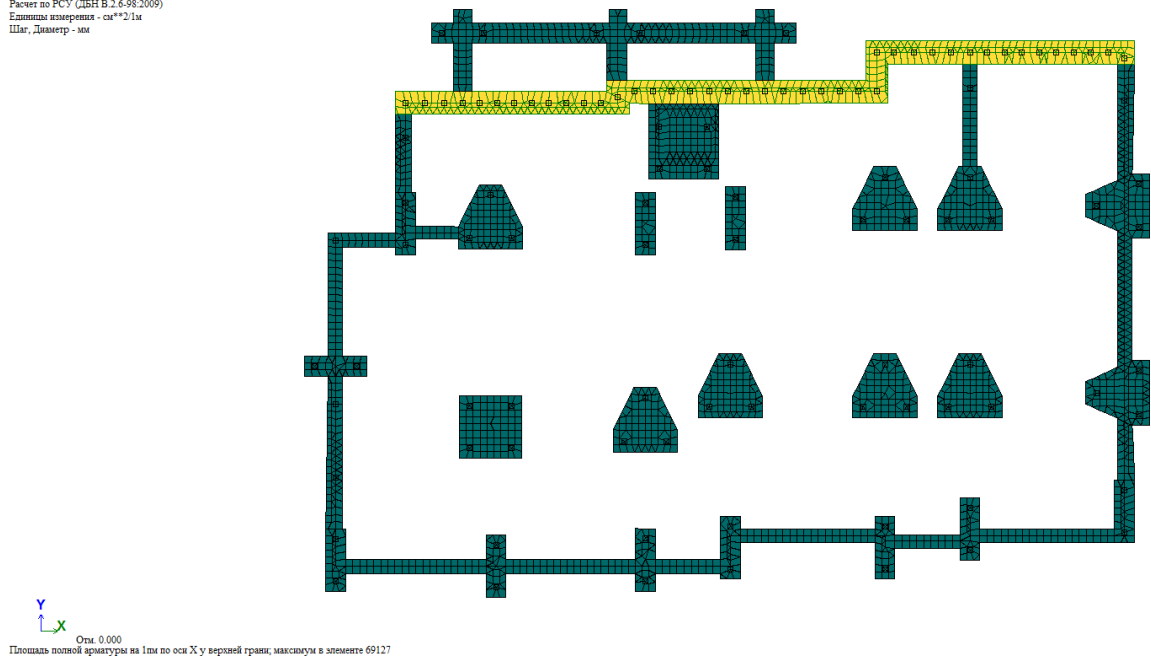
Епюра напружень та площа арматури на 1м.п. по X у верхній зоні балки-стінки
